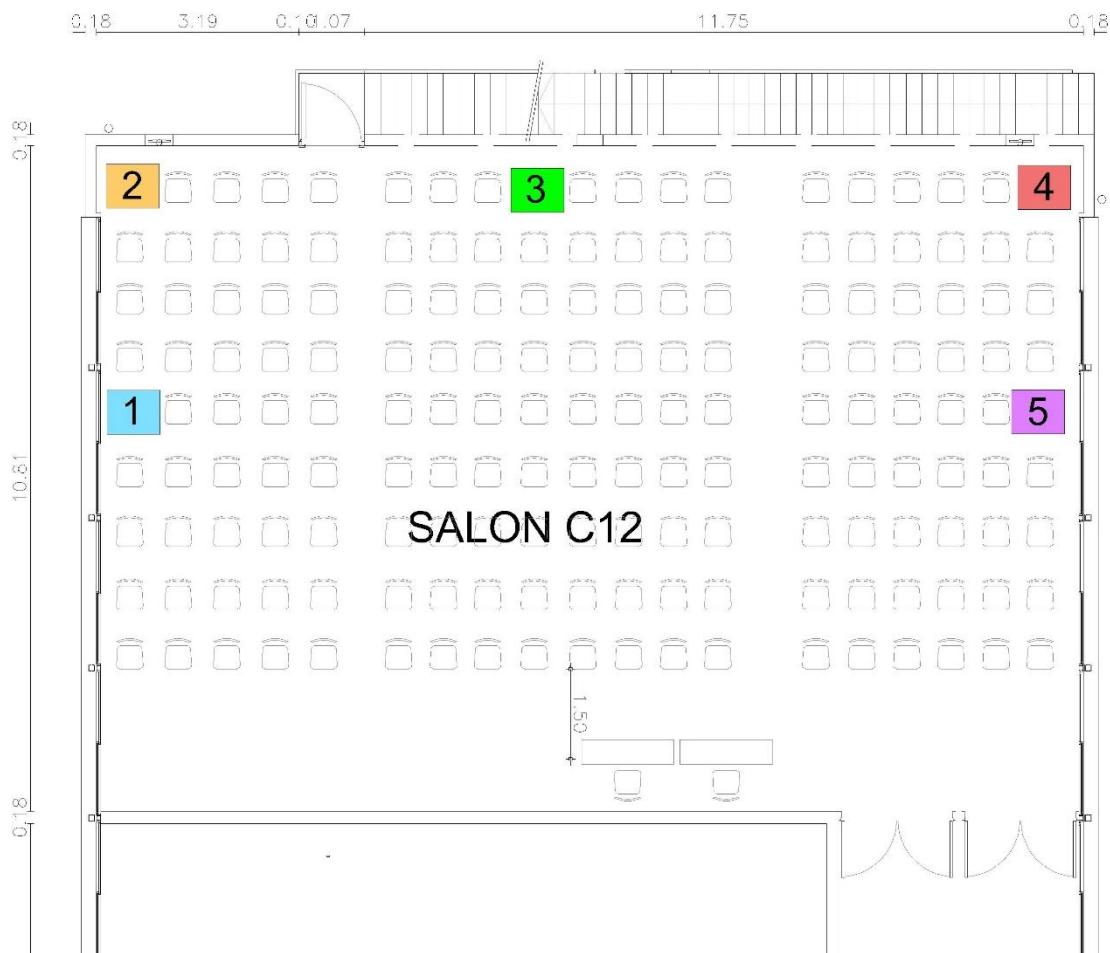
Planta salón C12 con ubicación de lugares para el ensayo
